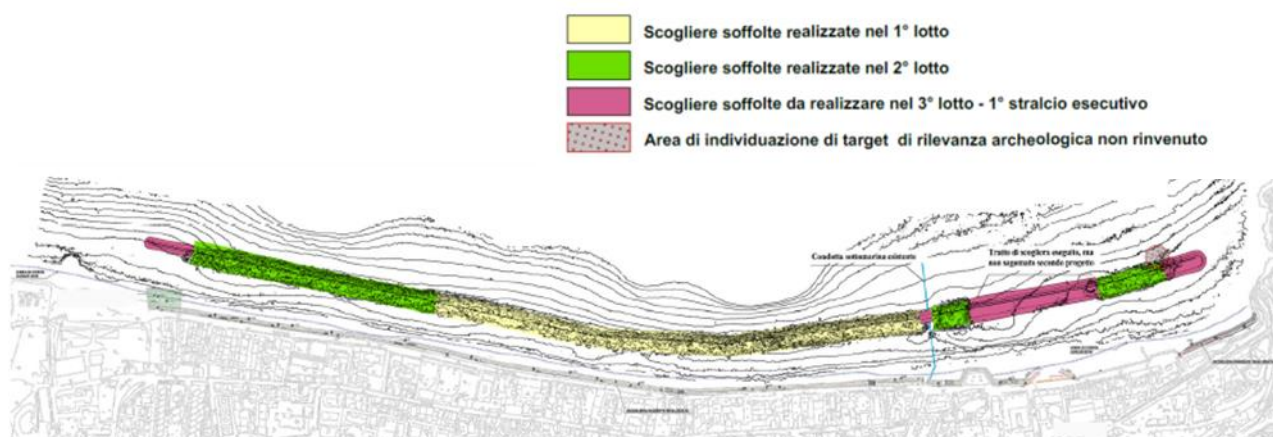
Planimetria lavori realizzati con il 1° stralcio funzionale del 3° lotto
